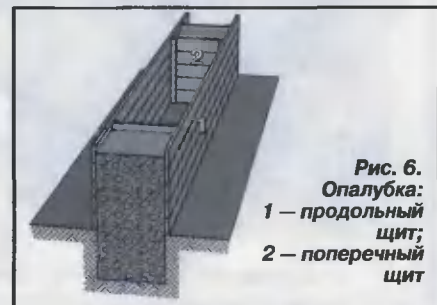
Опалубка: 1 — продольный щит; 2 — поперечный щит
